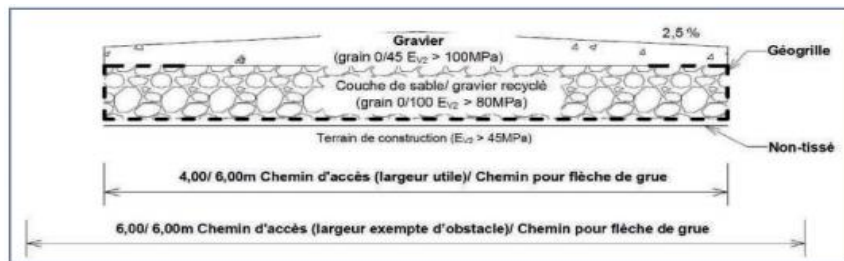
Type de remblais utilisé pour le renforcement des chemins
